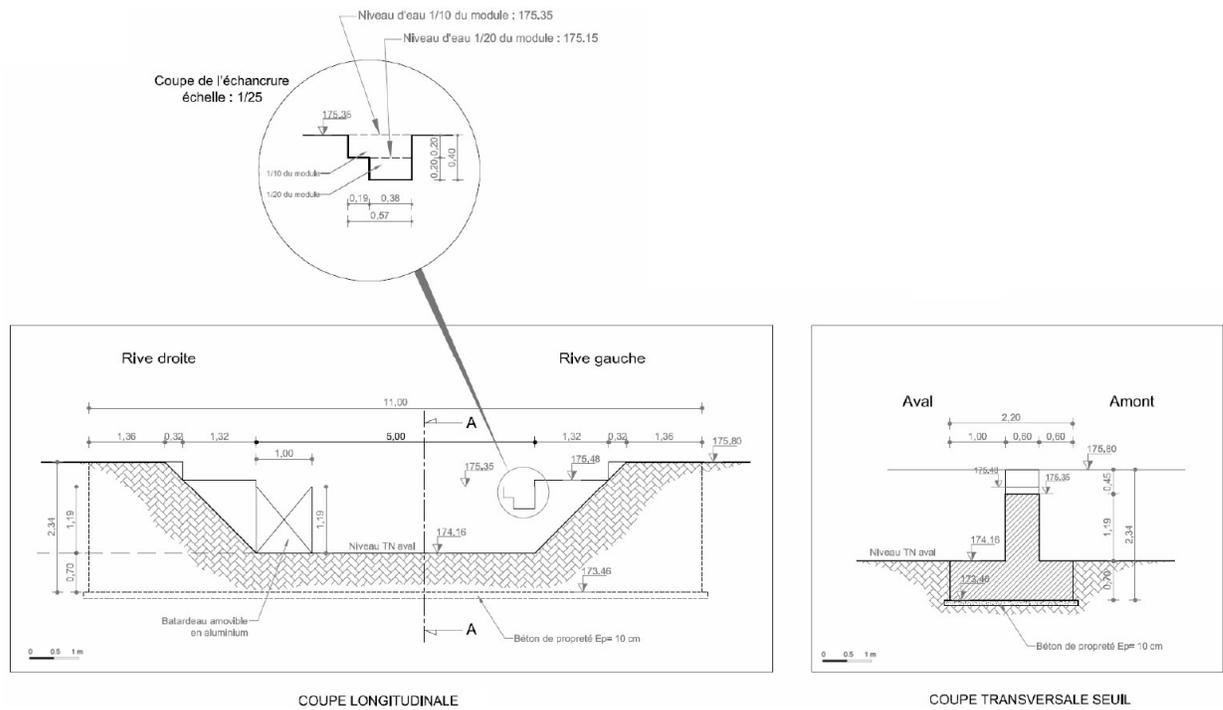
Coupe longitudinale et coupe transversale du seuil de Pont Saint Yves
